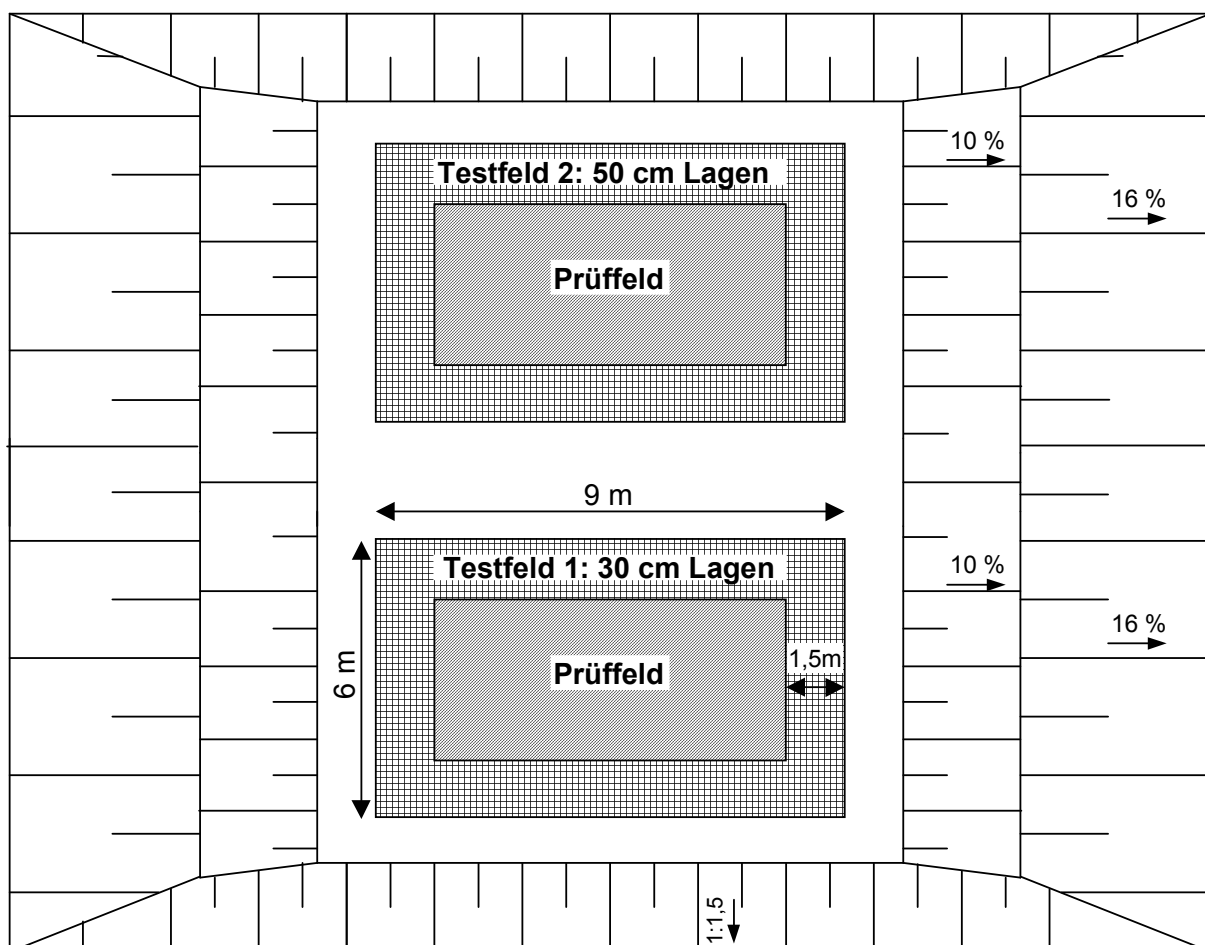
Ausführungszeichnung für den Bau der Versuchsfelder (ohne Maßstab)
